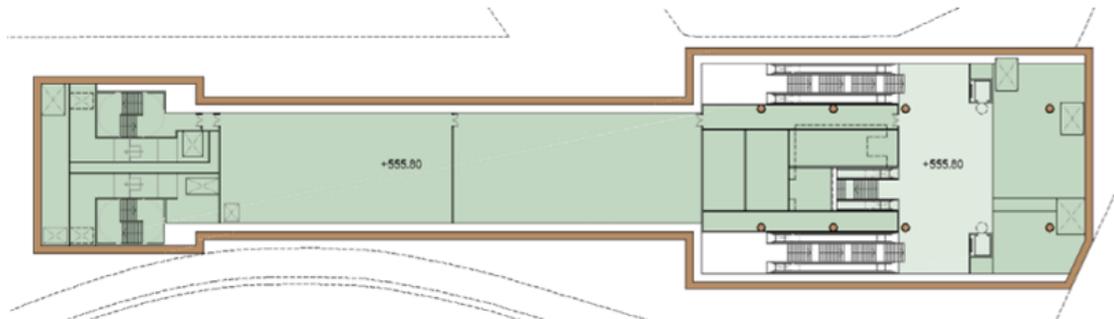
Planta preandén de la estación Madrid Río L11. Alternativa 1.
